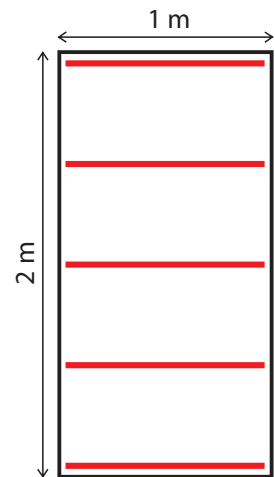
Parallel zu einer 1 m langen Wand installiertes Befestigungsband.
